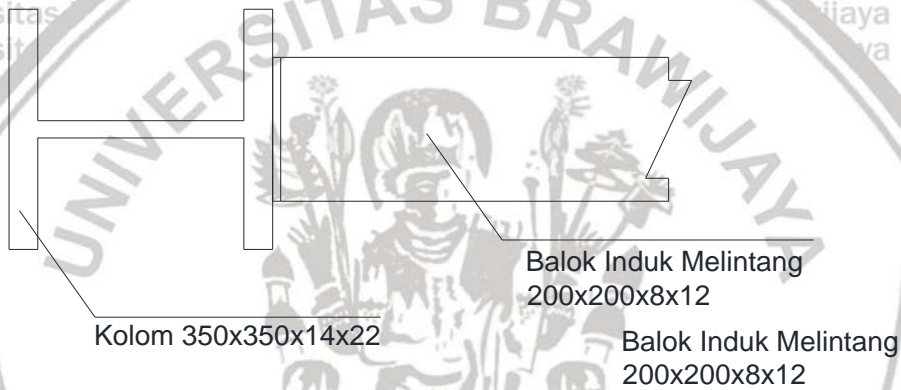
40 Tampak Depan Sambungan Balok Induk Memanjang ó Kolom
